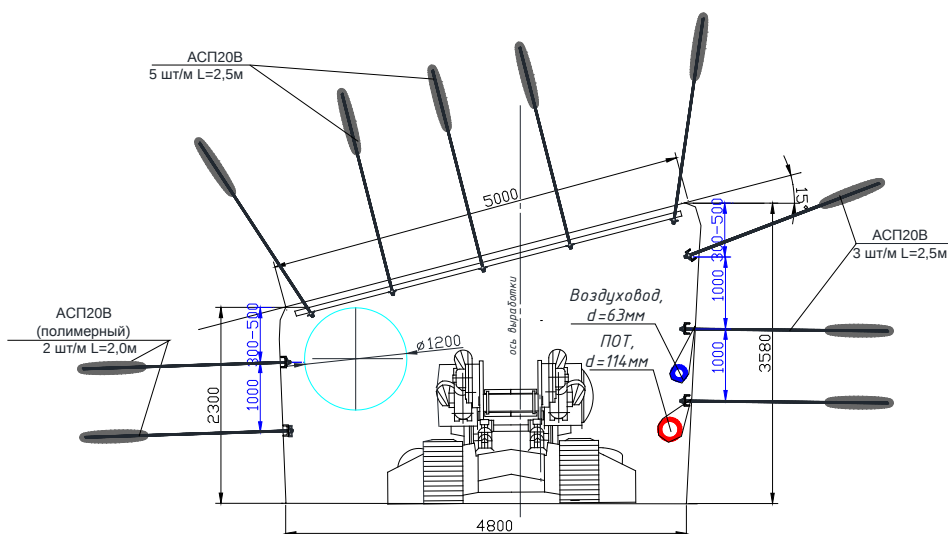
Поперечное сечение вентиляционного штрека (предлагаемый вариант)
